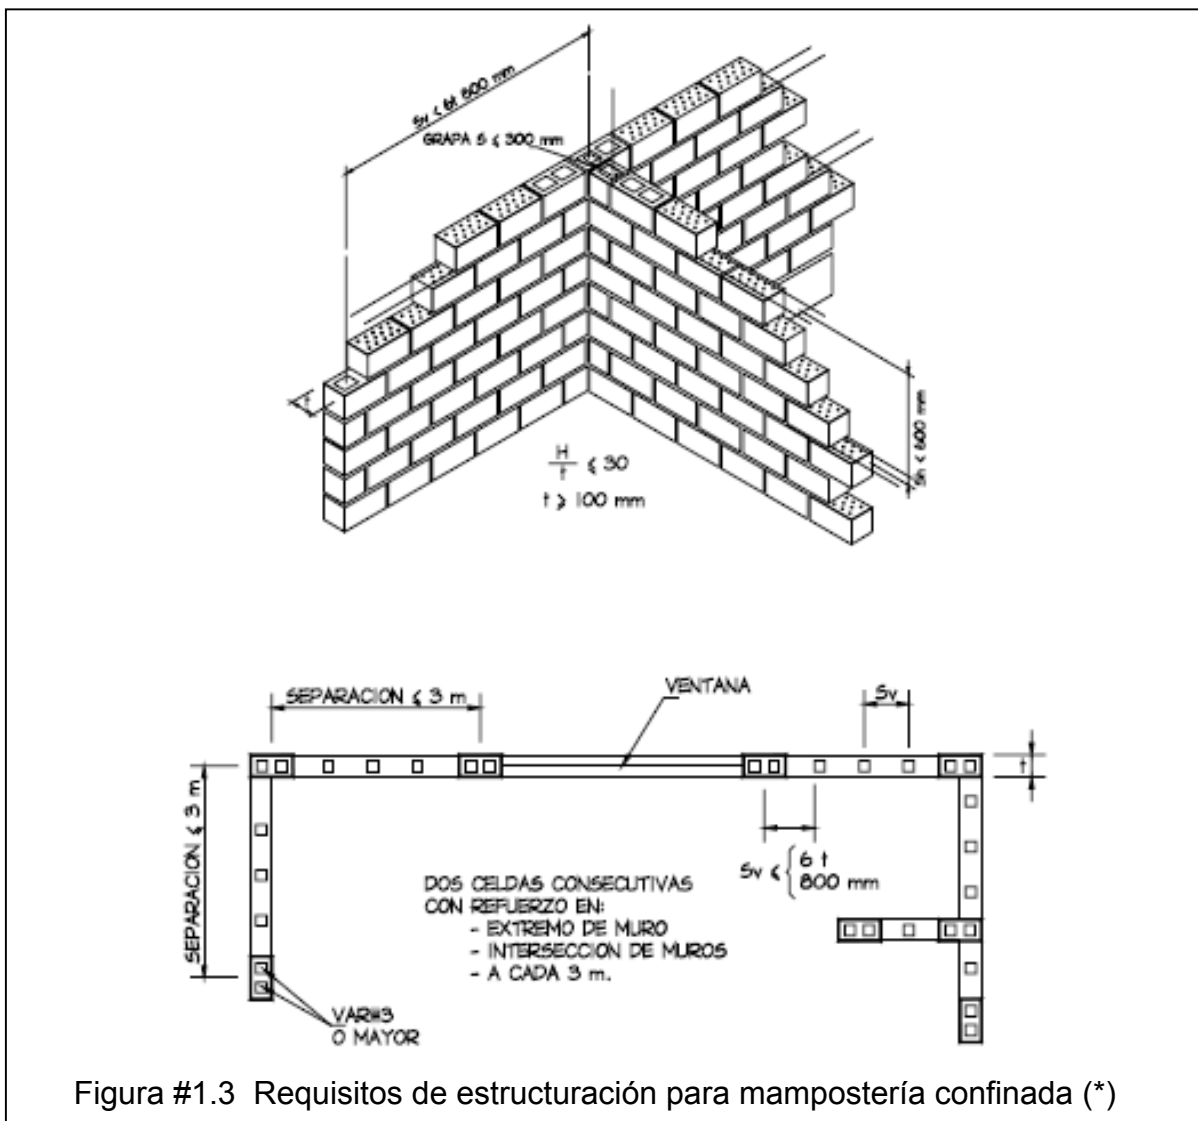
Requisitos de estructuración para mampostería confinada (*)
